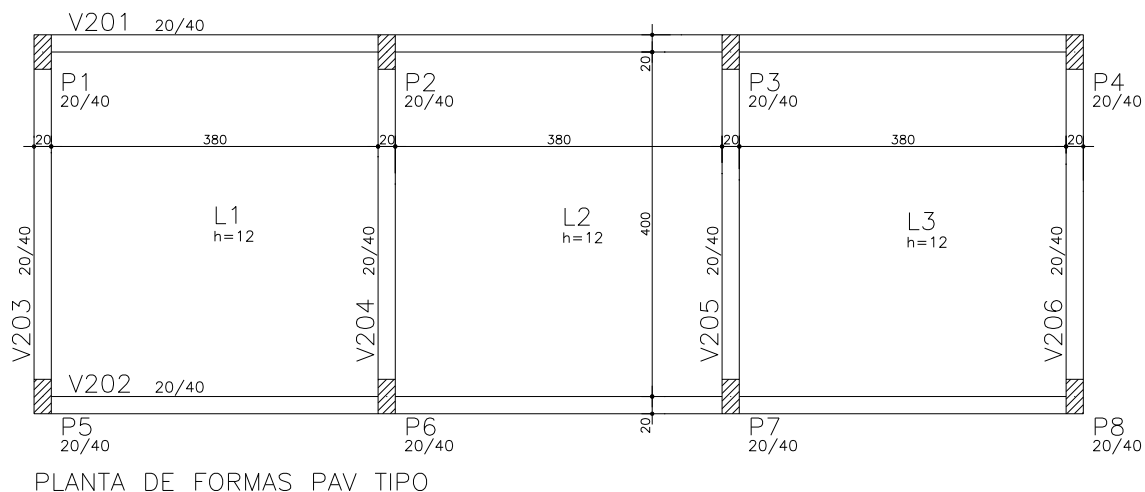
Planta de formas do pavimento tipo: T1 -5P1V1
